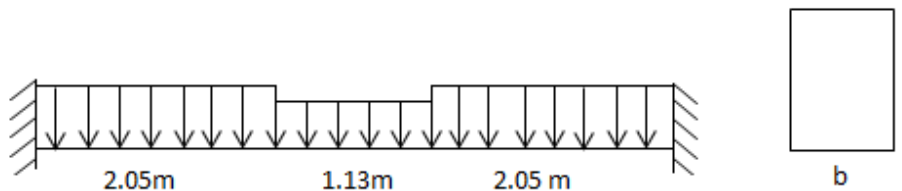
Schéma Statique de la poutre brisée (escalier type 01)
